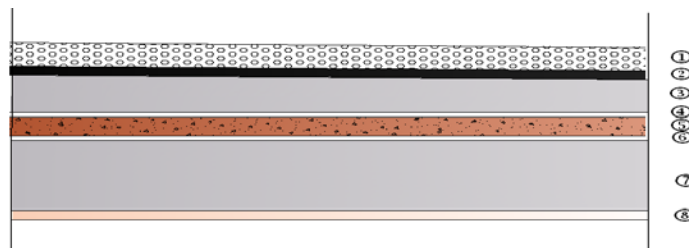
coupe transversale d'une dalle pleine de la salle machine
